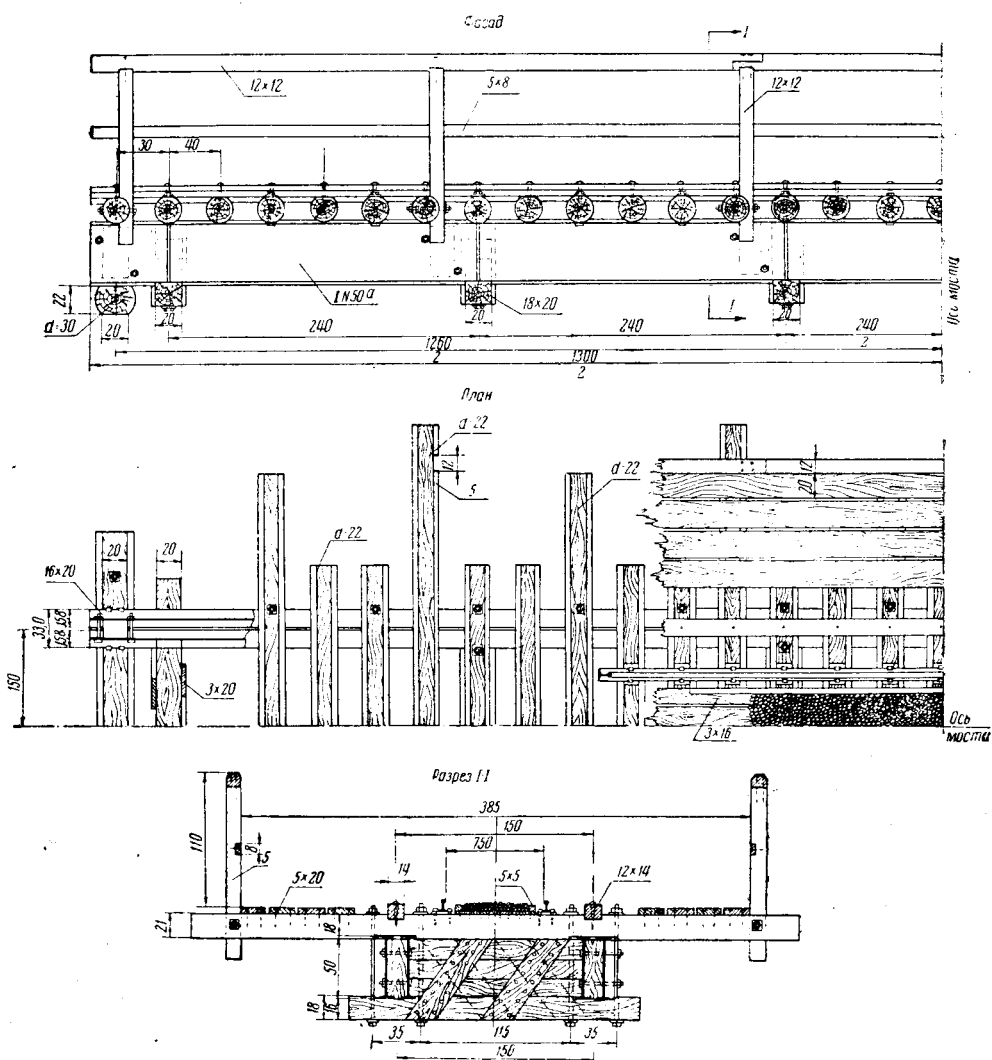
Металлический пакет (для перекрытия сплавного пролета) из двутавровых балок под нагрузку паровозом 159
